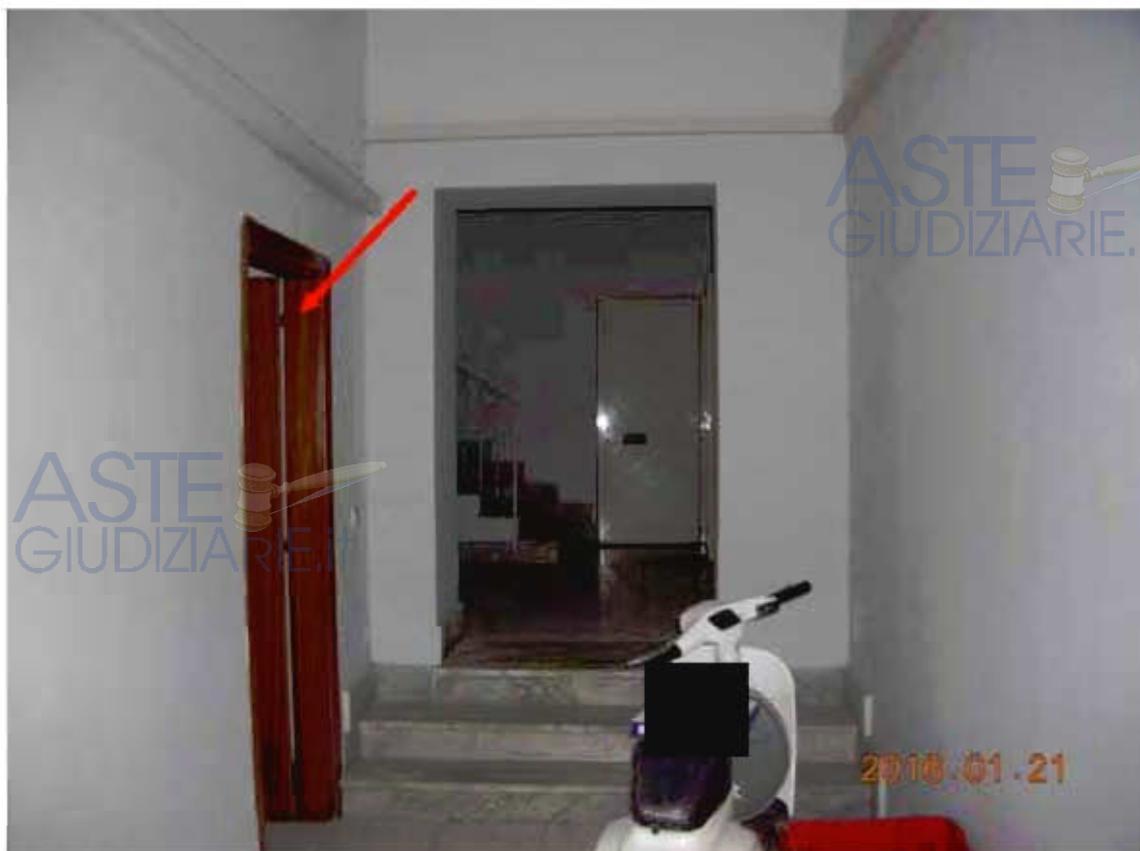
Vano porta che conduce all'interno dell'immobile Sub 2 dal vano scale
